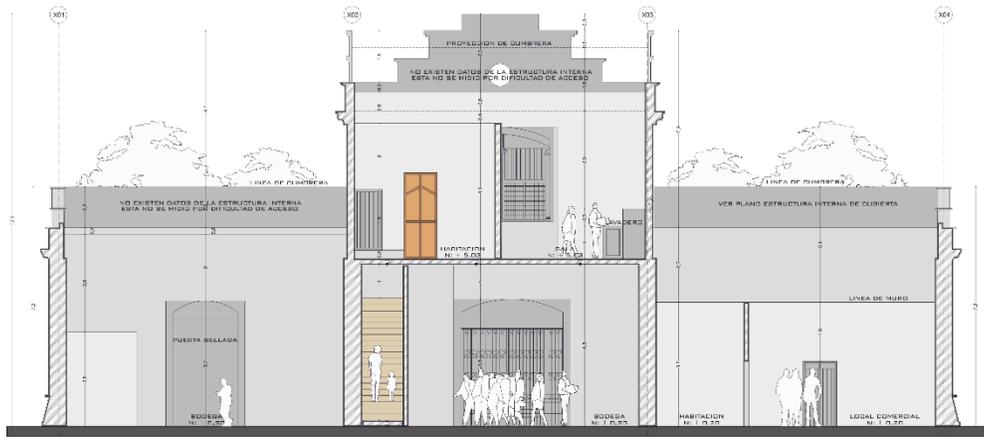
Sección longitudinal A-A, Estación del ferrocarril Sur.
